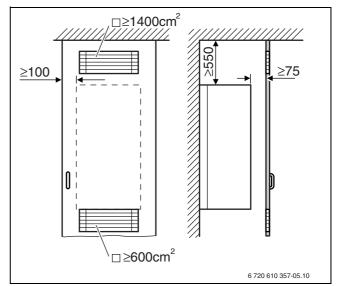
Griglie di aerazione obbligatorie, in caso d'installazione in armadietto copricaldaia
